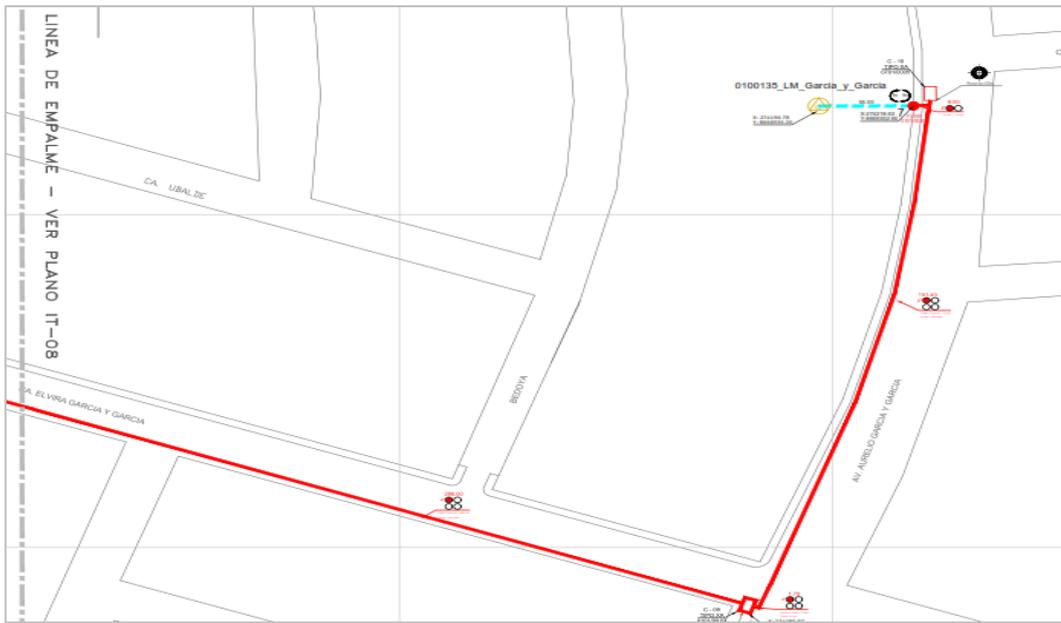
Plano de instalación de F.O - canalizado e instalación de un poste/Site Garcia
